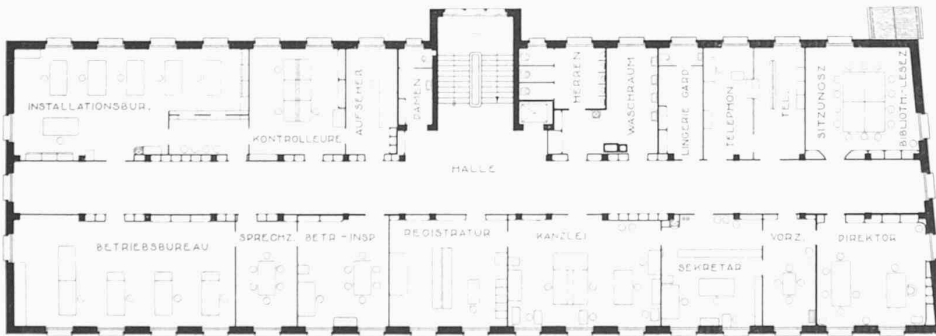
Grundriss vom II. Stock. — Masstab 1 : 400.
